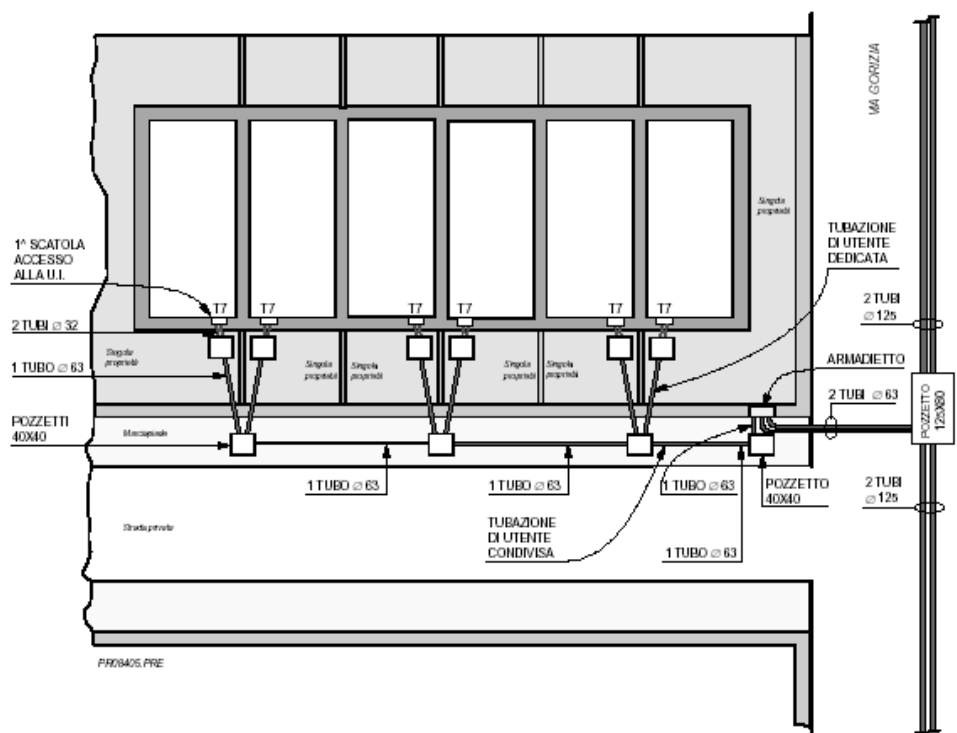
Esempio di predisposizioni tipo case a schiera con armadietto
